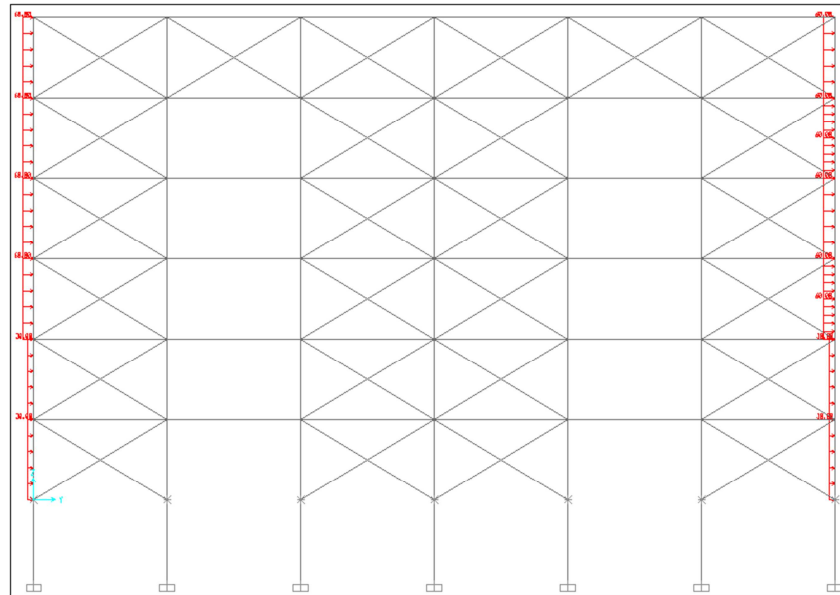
Carga de Viento en el eje Y (V_y) aplicadas a la forma estructural, sección longitudinal.
